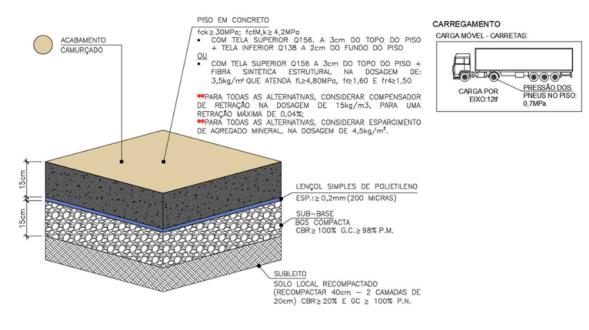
Perfil do pavimento da área externa de circulação - áreas críticas
